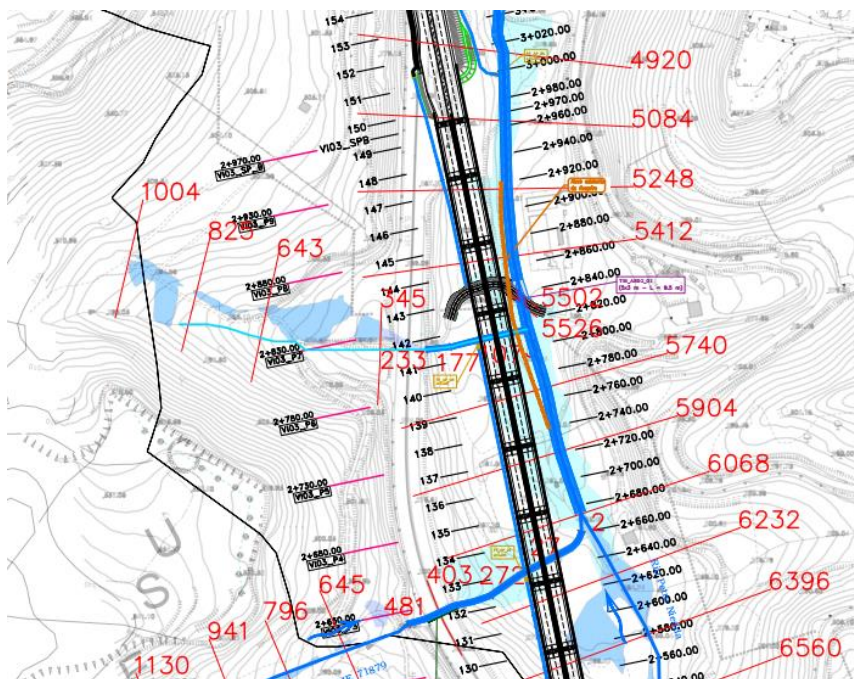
Situazione Post Operam, eliminazione degli allagamenti a monte dei rilevati stradali
